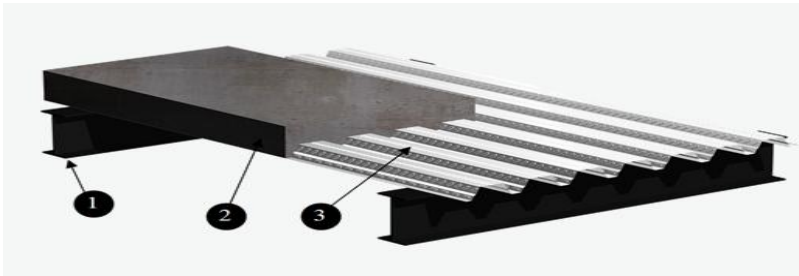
Переріз сталезалізобетонної плити по сталевому профнастилу із виштампками: 1 – балка перекриття (основна несуча система будівлі); 2 – бетон; 3 – профнастил ТП-85 (арматура, незнімна опалубка; основний код ТПК -02); 4 – шуруп (гвинт) нефарбований (кріплення профнастилу ТП-85 до балок перекриття; основний код ТПК – 14)
